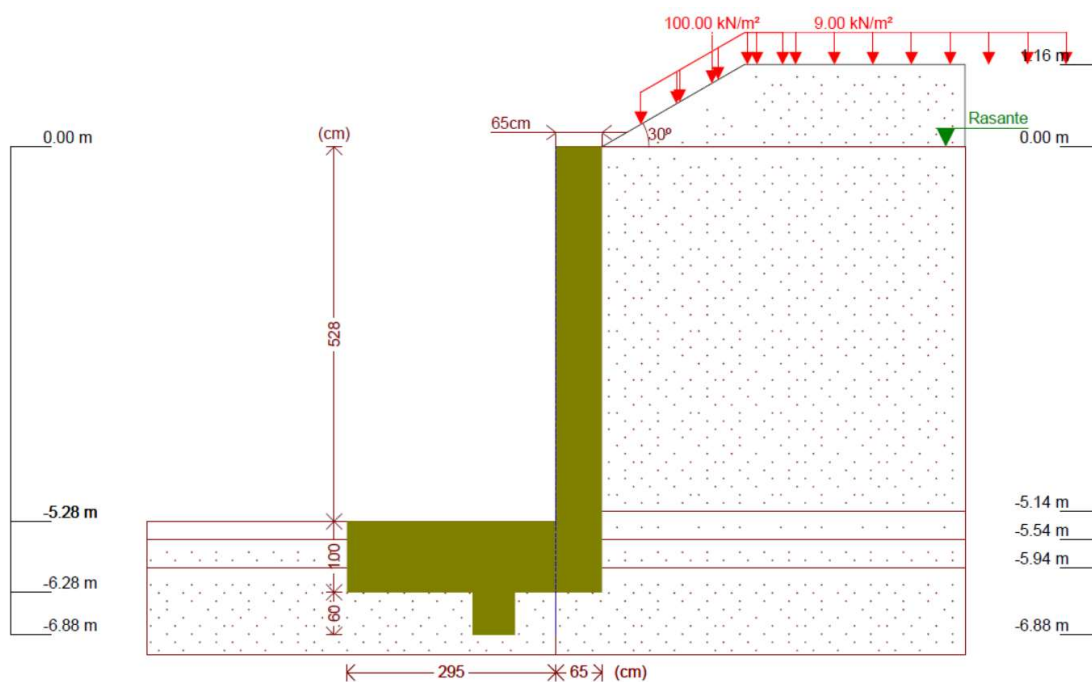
Modelo de muro de hormigón armado 1, del tramo de muro bajo el tablero del paso superior. Fuente: propia (elaborado con CYPE)
